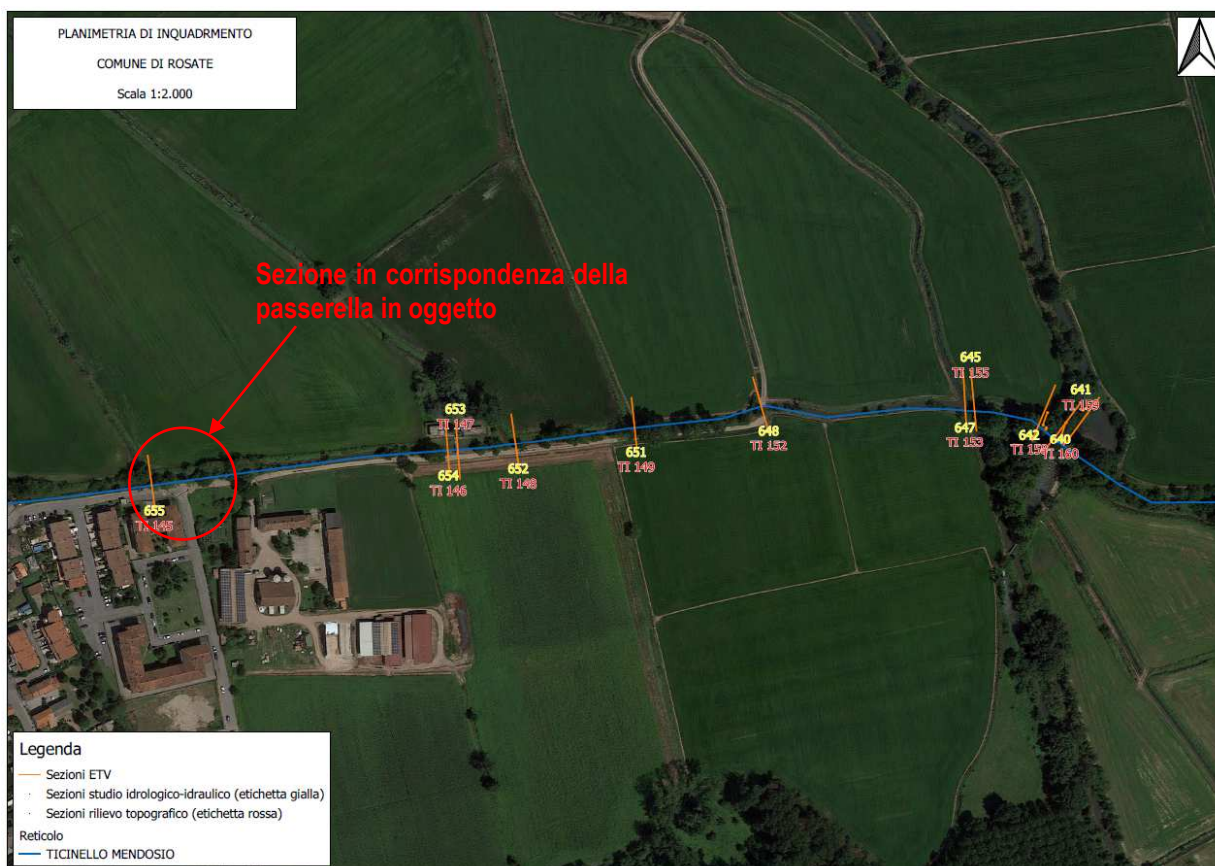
Planimetria con riportate le sezioni trasversali del Ticinello
